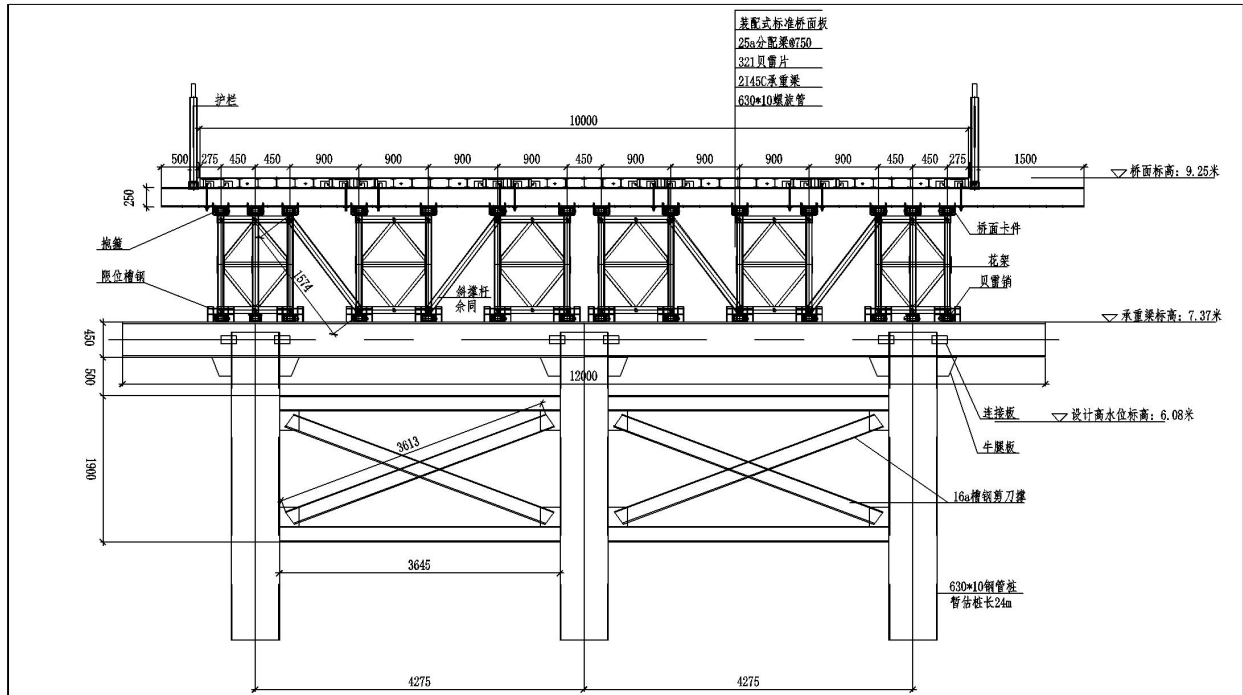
10米宽主栈桥首跨型钢剖面图
